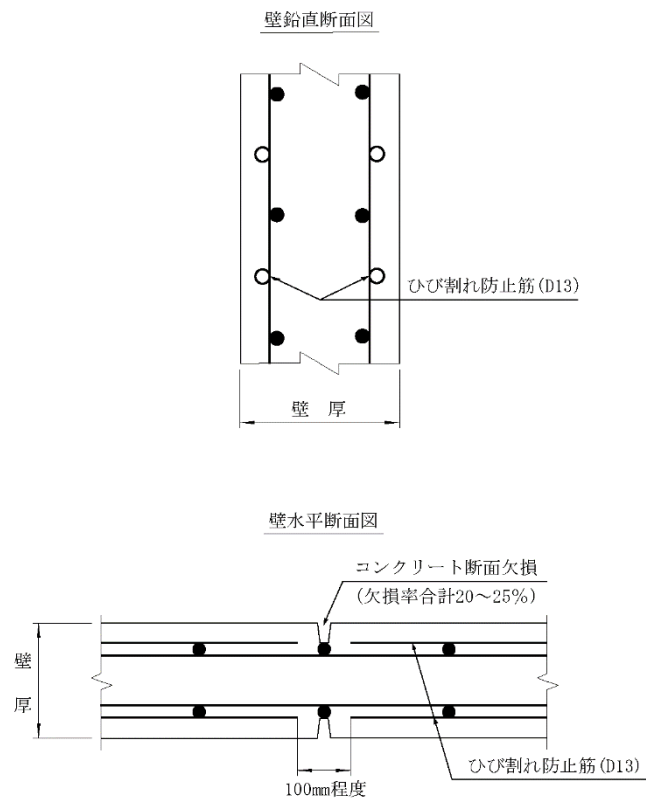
ひび割れ誘発目地の設置例
